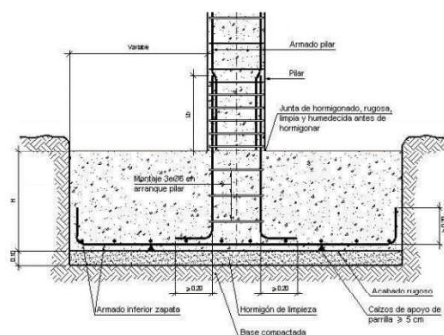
Sección de la zapata de cimentación. Fuente: cype
